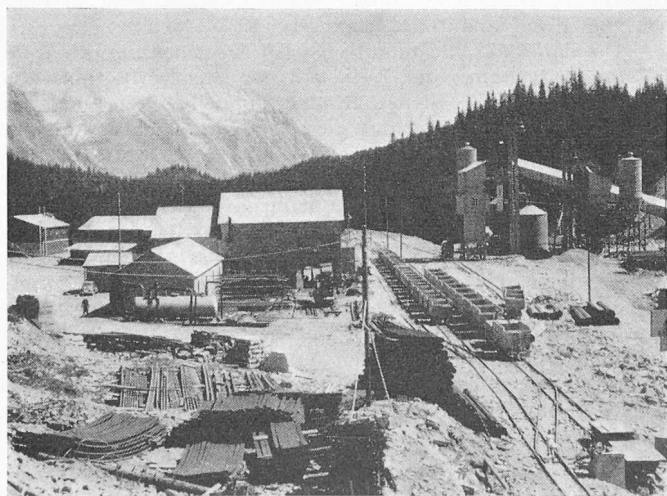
Uebersicht über den Installationsplatz. Links Büros, Werkstatt und Kompressorenstation, rechts Betonaufbereitungsanlage
